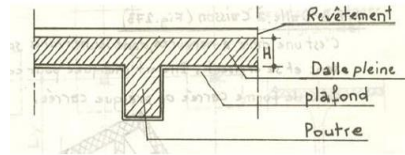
La dalle pleine (source : KASSOUL.A, cours : bâtiment 2, chapitre 01 : plancher, pp 10)
